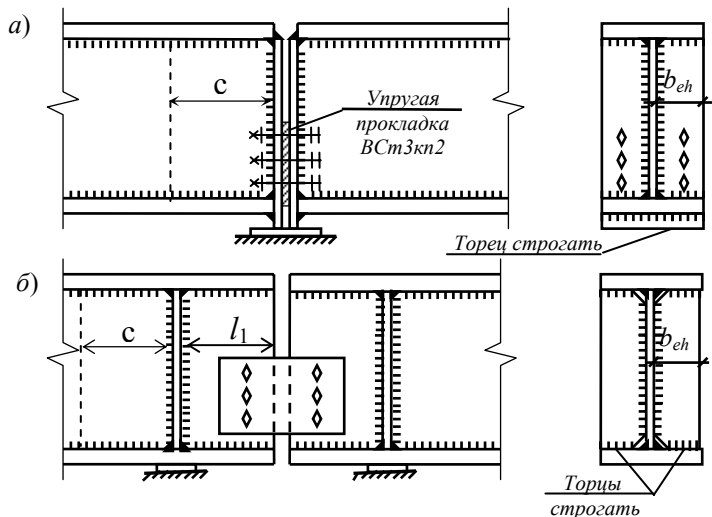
Конструкция опорных частей сварных балок:
